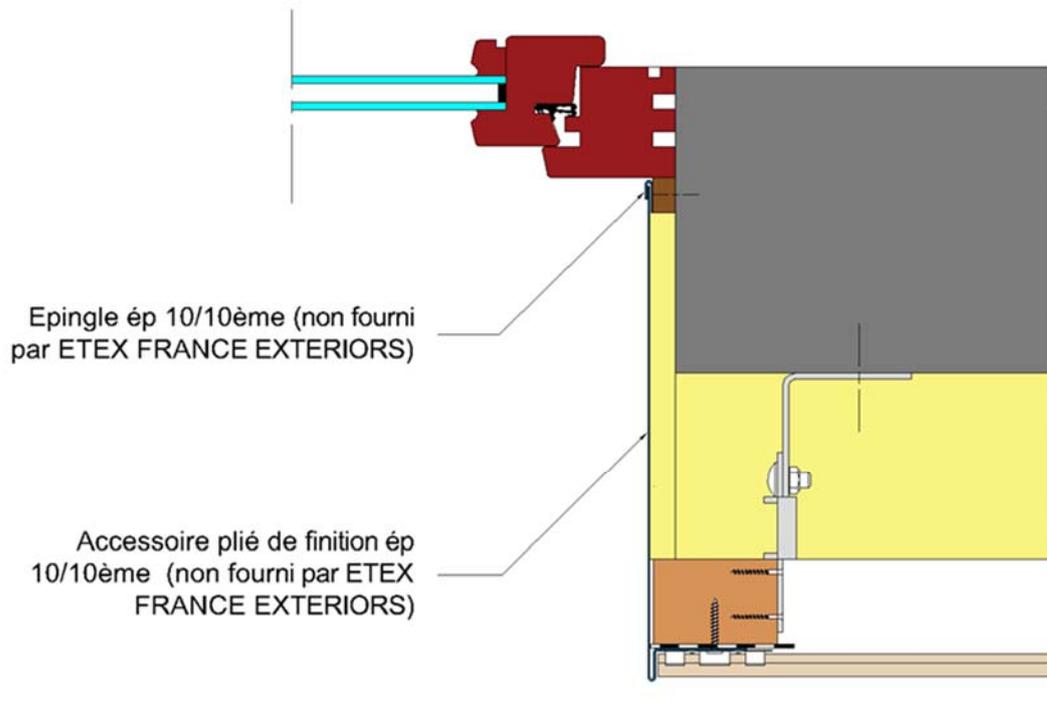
is – Coupe sur tableau avec CEDRAL BOARD
